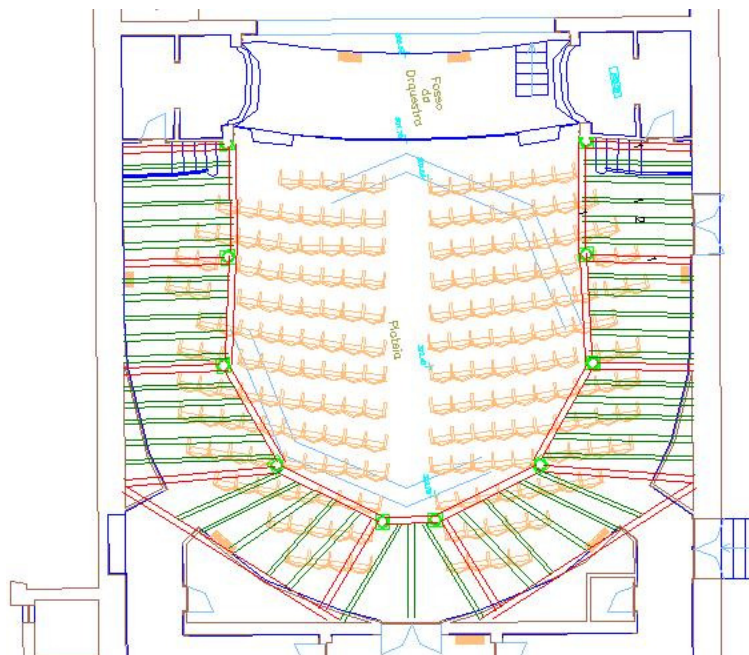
Planta com distribuição típica dos elementos estruturais dos pavimentos de madeira. A vermelho as vigas principais e a verde as secundárias.
